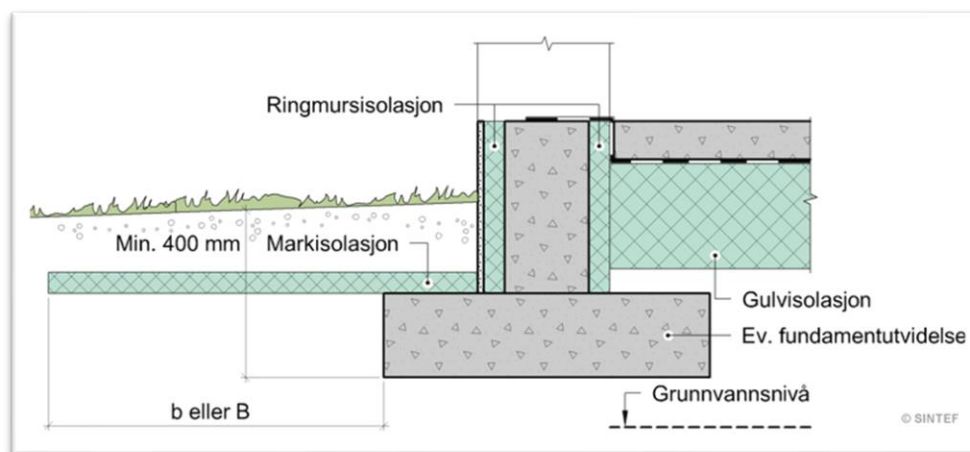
Betonggulv på grunn med underliggende varmeisolering (BKS 522.111).
